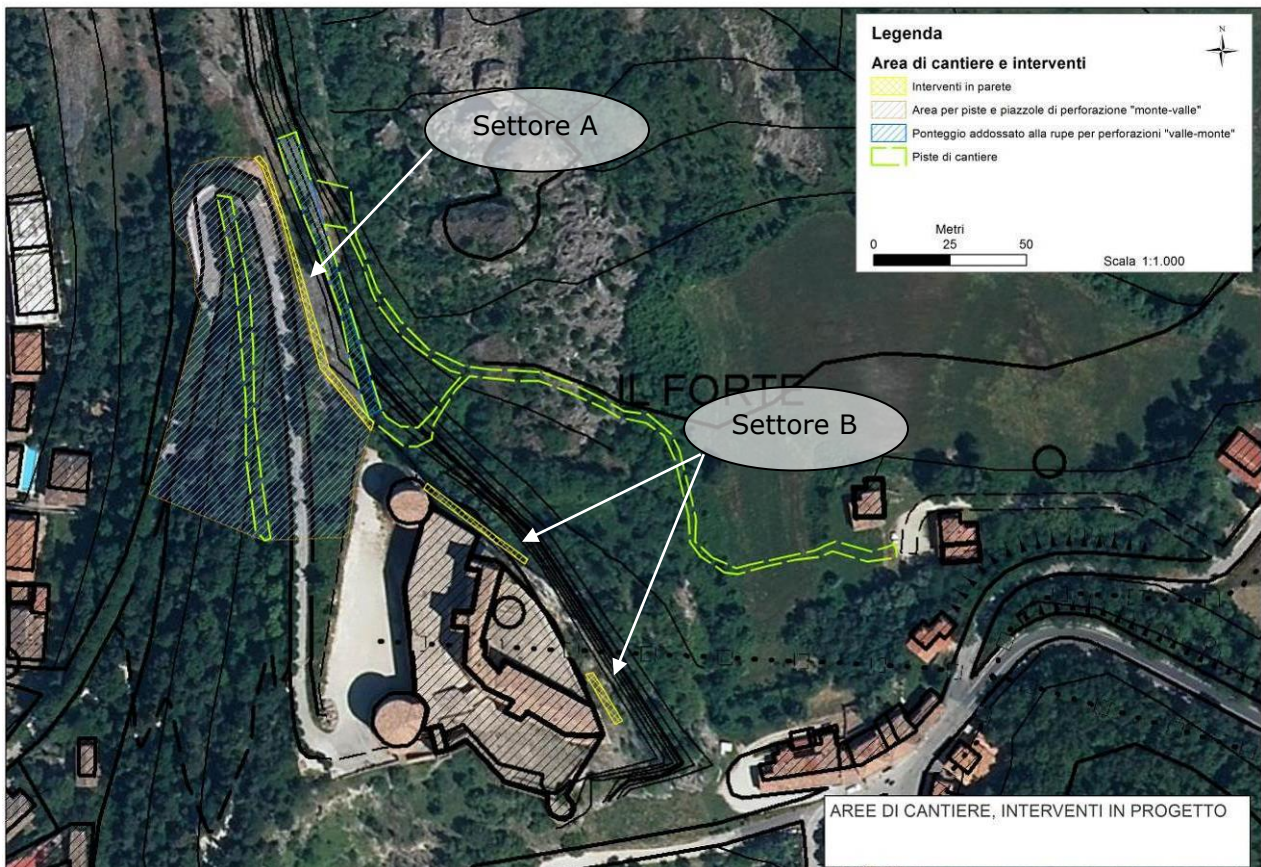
Aree di cantiere previste per la realizzazione delle opere in progetto
